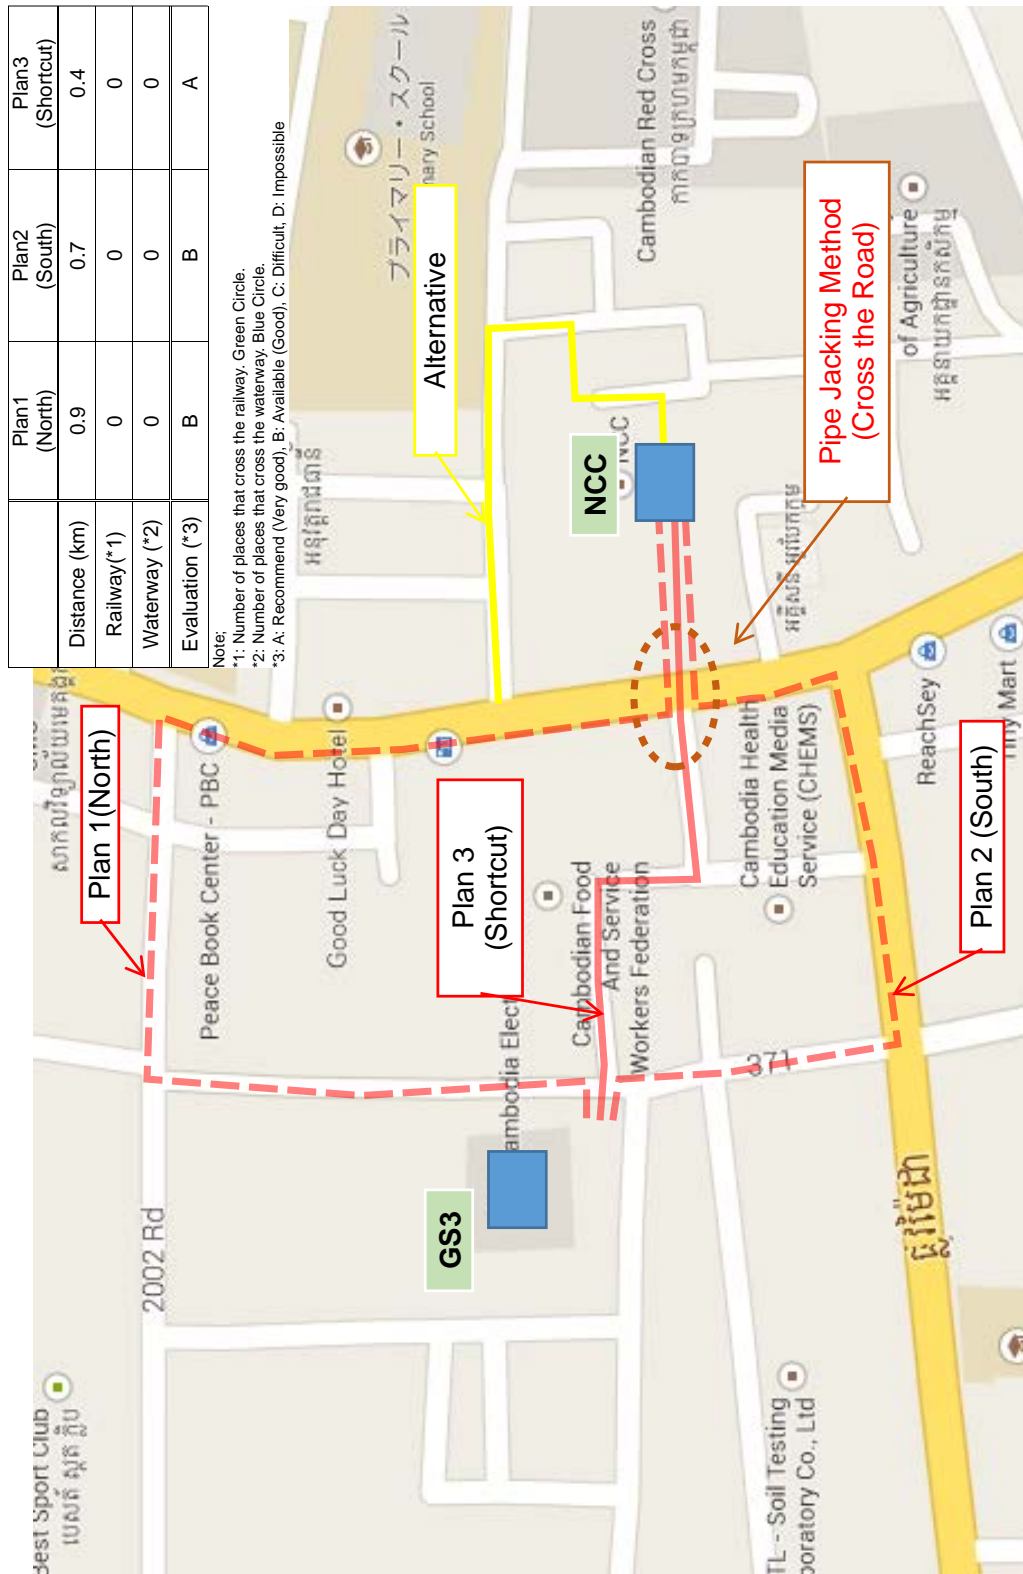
UG_Route2 平面図 (現地調査結果)
